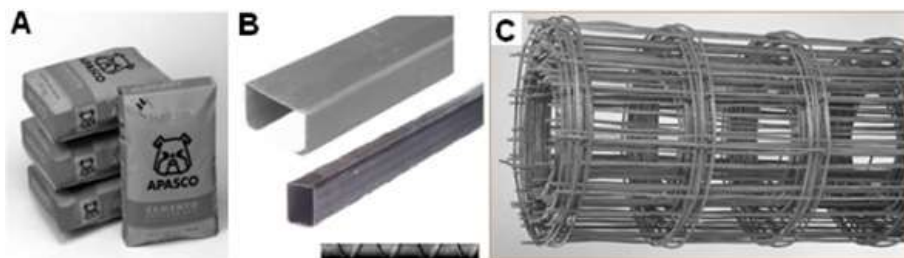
Materiales industriales, foto A, Cemento; foto B, perfil metálico para columnas y vigas, acero de 3/8" para reforzar las paredes con castillos; foto C, malla electro soldada para reforzar el techo de concreto de compresión.
